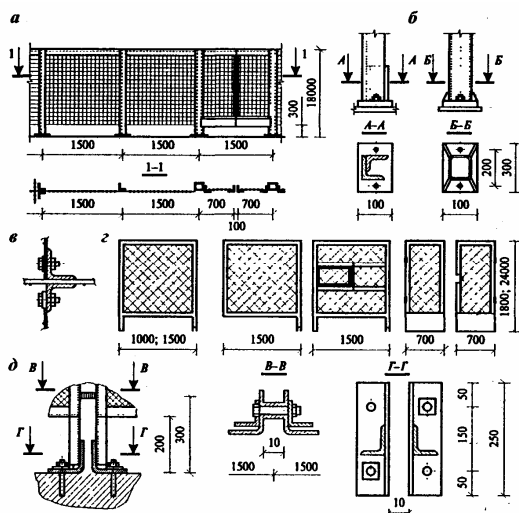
Выгораживающие перегородки из стальной сетки:
